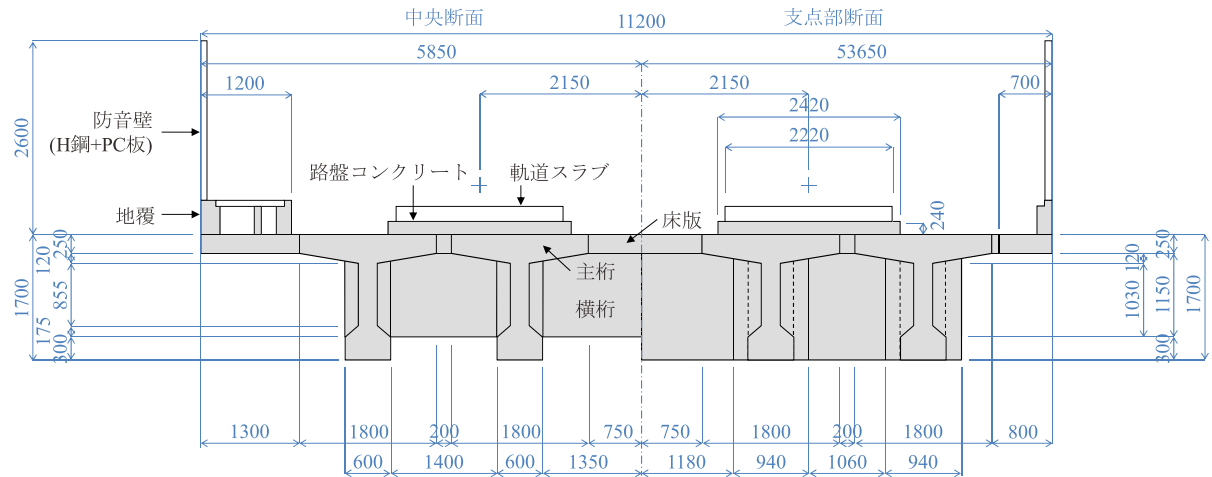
検討対象 PRC 桁の断面図 (単位: mm) (着色箇所がモデル化範囲)
